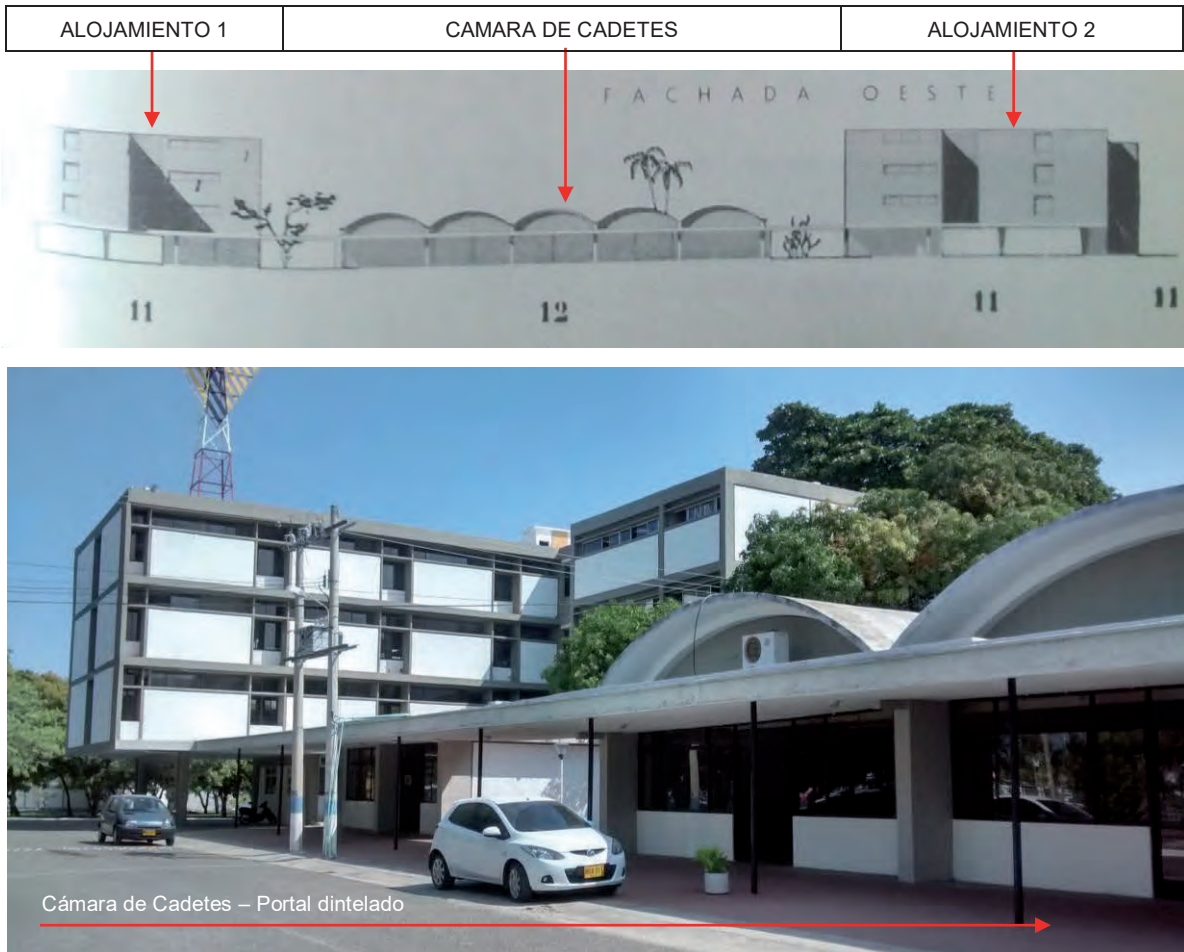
Plano fachada oeste edificio Alojamientos y cámara de cadetes, 1955. Fotografía de la misma fachada donde se observa el portal dintelado, parte de las bóvedas que cubren la cámara de cadetes y al fondo entremezclado en la naturaleza (patio interno), uno de los edificios de alojamiento. Fuente: Plano Fachada oeste, Revista Proa No. 91, agosto de 1955. Fotografía cámara de cadetes, archivo personal, 2015.
